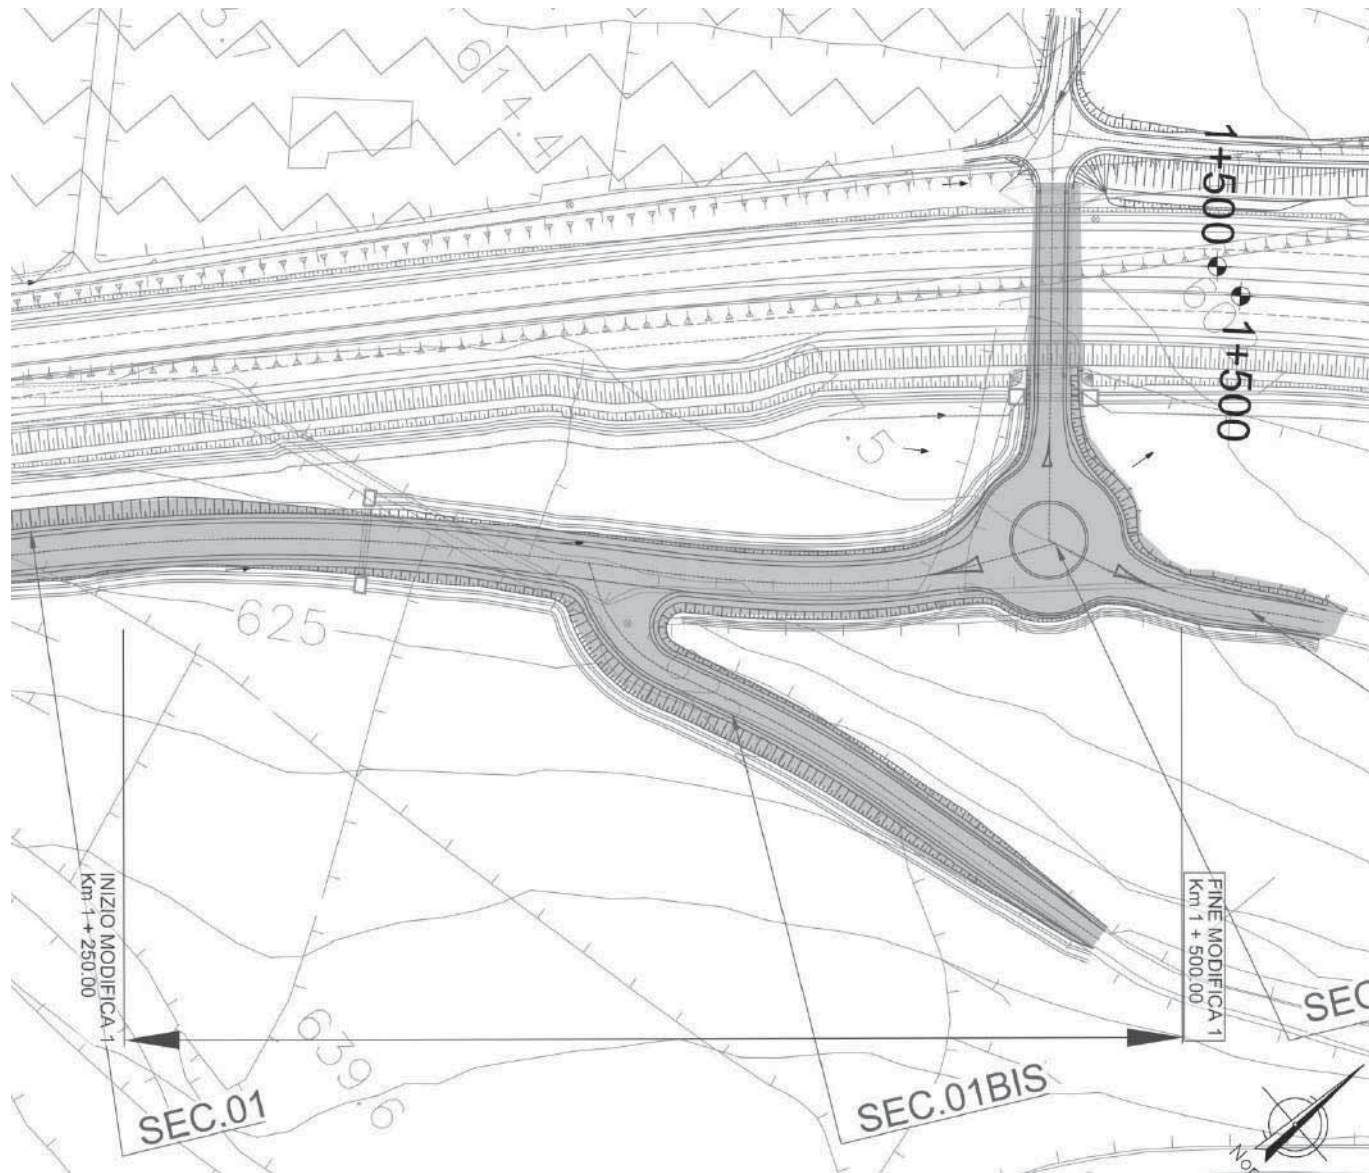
Stralcio planimetrico viabilità sec.01 (Progetto Esecutivo)
